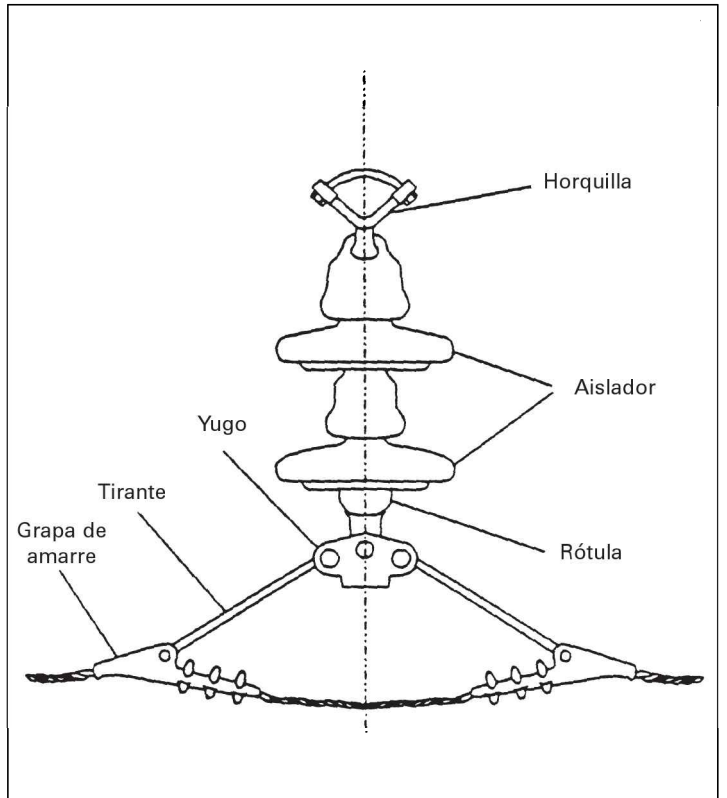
Cadenas de suspensión derivación con aisladores de vidrio.
